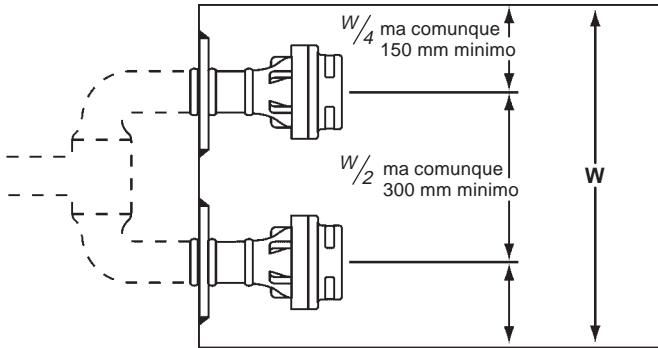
Installazione con due iniettori in parallelo (vista in pianta)
